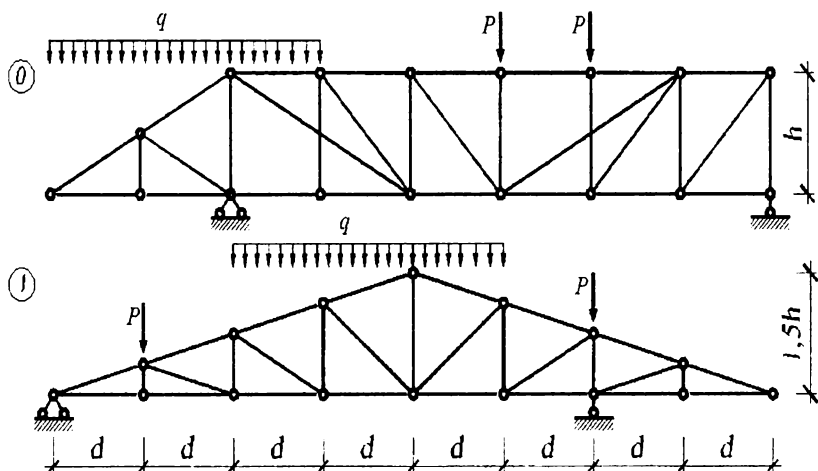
Схемы ферм к выполнению расчётных работ
